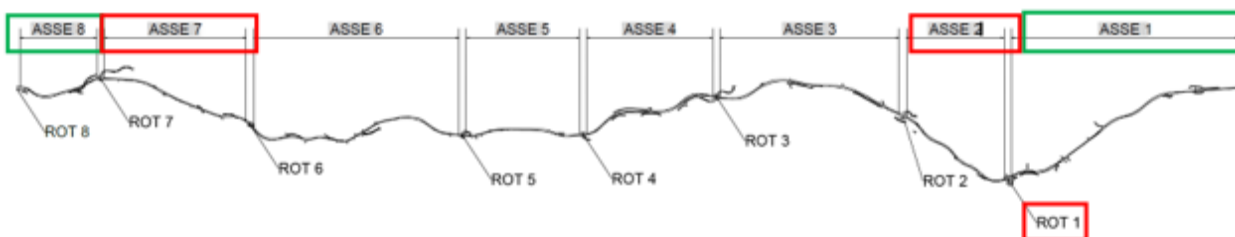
FASE 2 DI CANTIERIZZAZIONE
